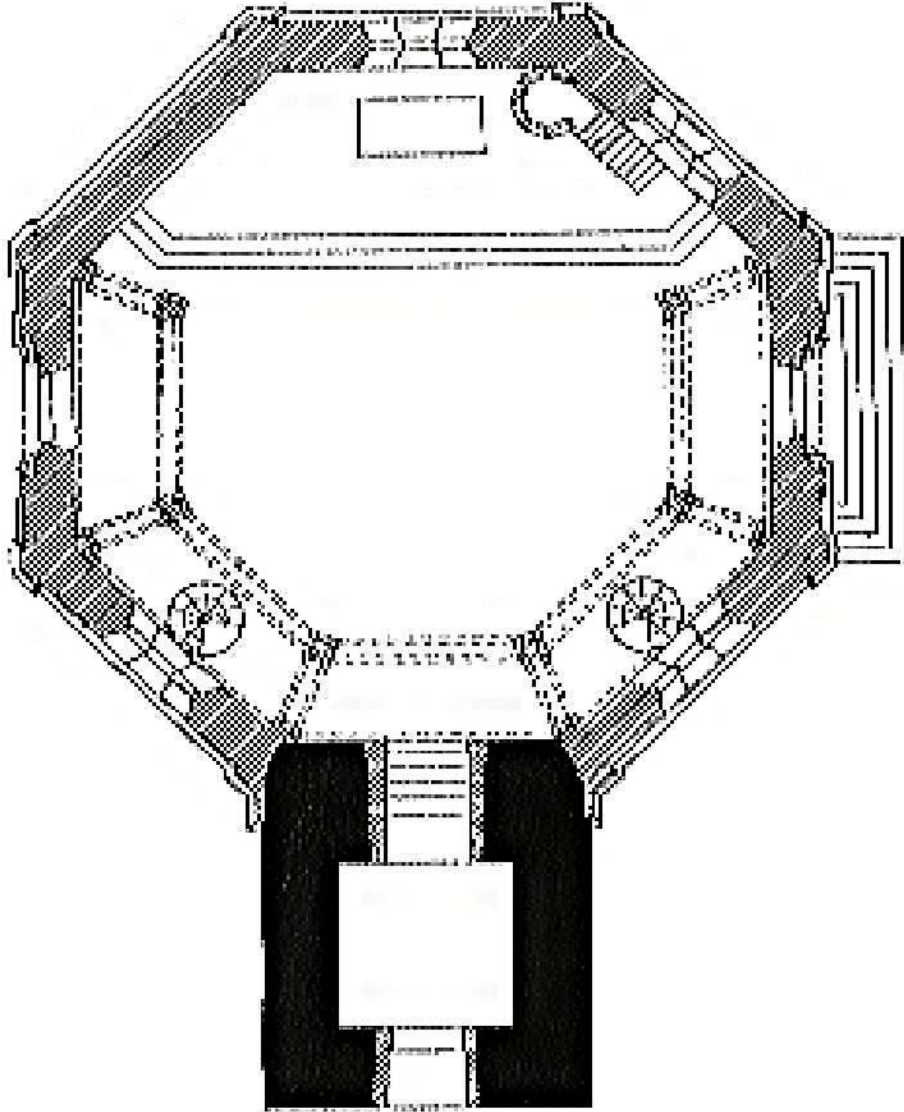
Evangelische Kirche Urbach (1830), Grundriss Erdgeschoss
